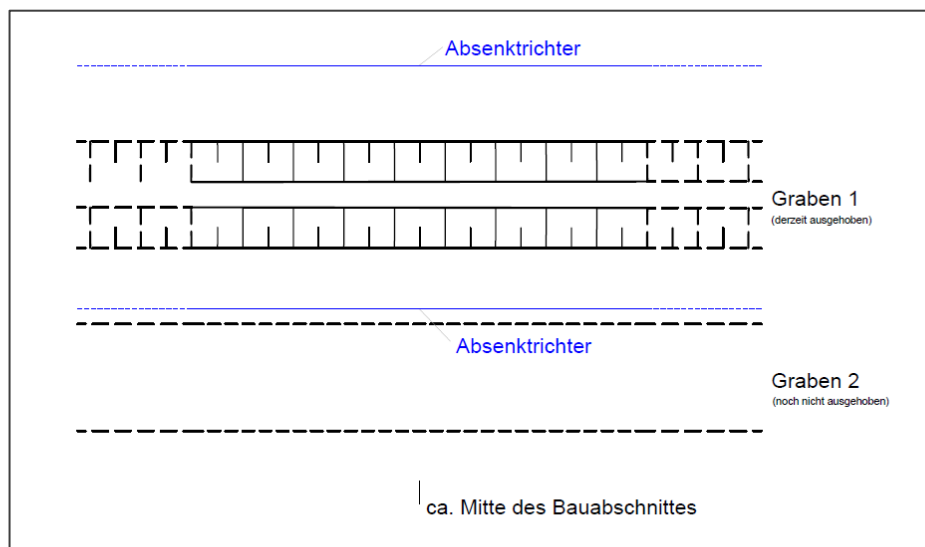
Prinzipsskizze offene Wasserhaltung bei Graben 1 im Grundriss
